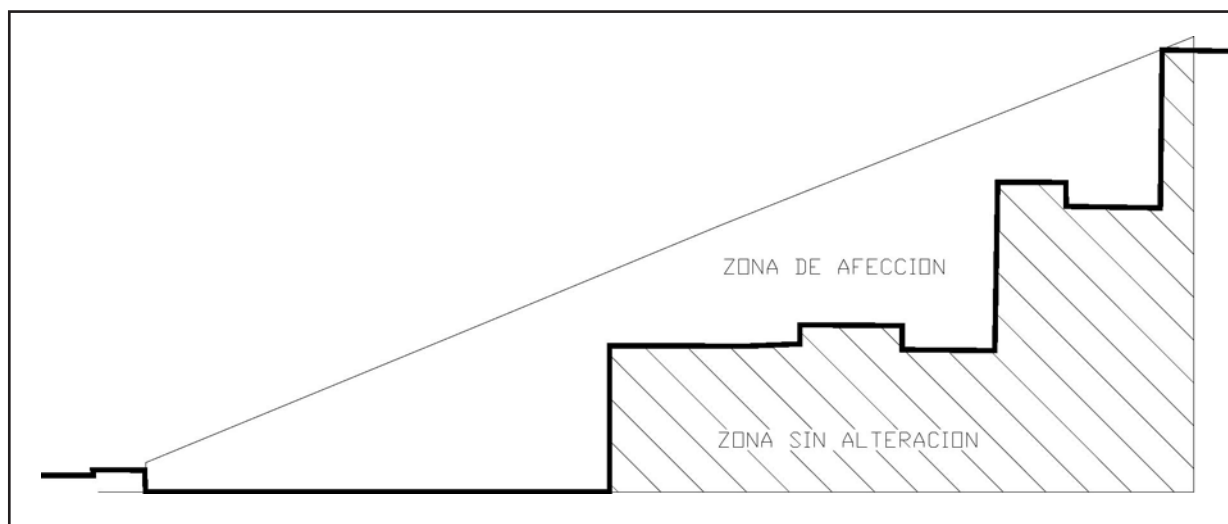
Alzado del Proyecto de Construcción de una vivienda unifamiliar.
